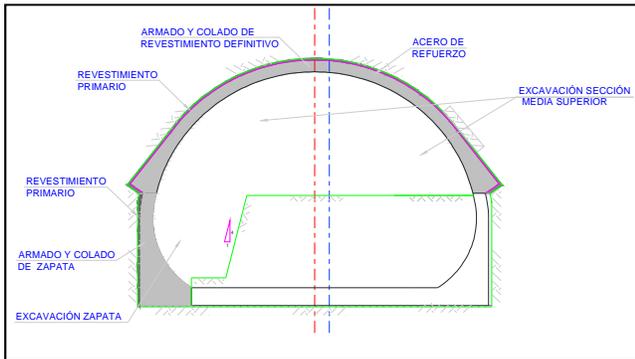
Corte de excavación y revestimiento de Zapata 1
